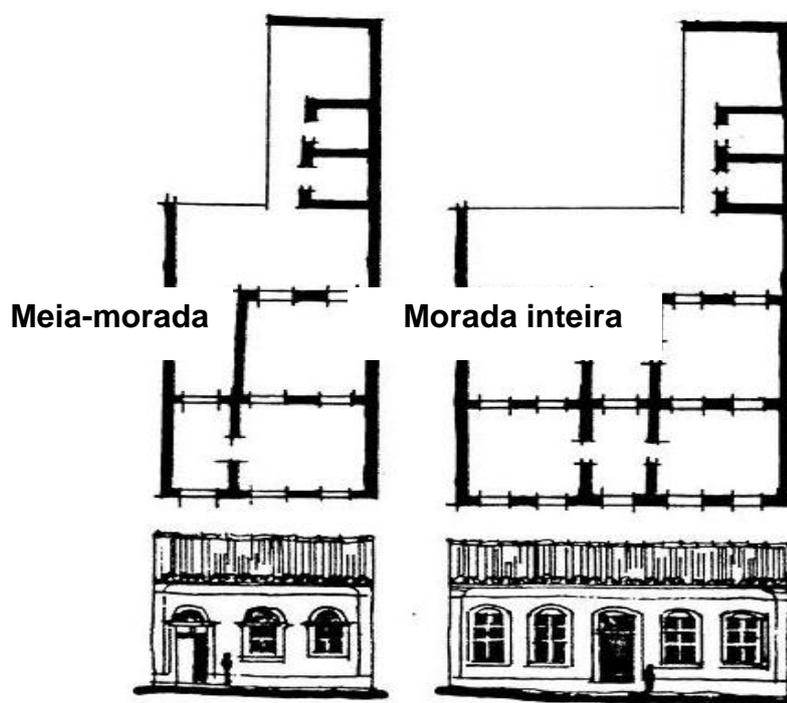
e 98 – Plantas baixas esquemáticas do prédio em estudo e da casa de morada-inteira.
